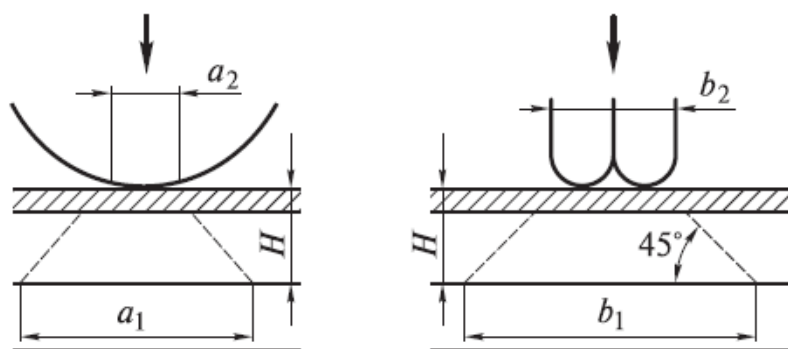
Схема распределения усилия от колеса по площади плиты
